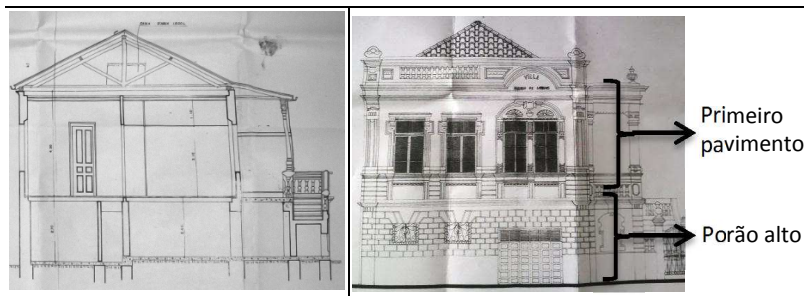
Exemplo de edificação com pavimento denominado porão alto: corte e fachada da Aliança Francesa (IE008)
